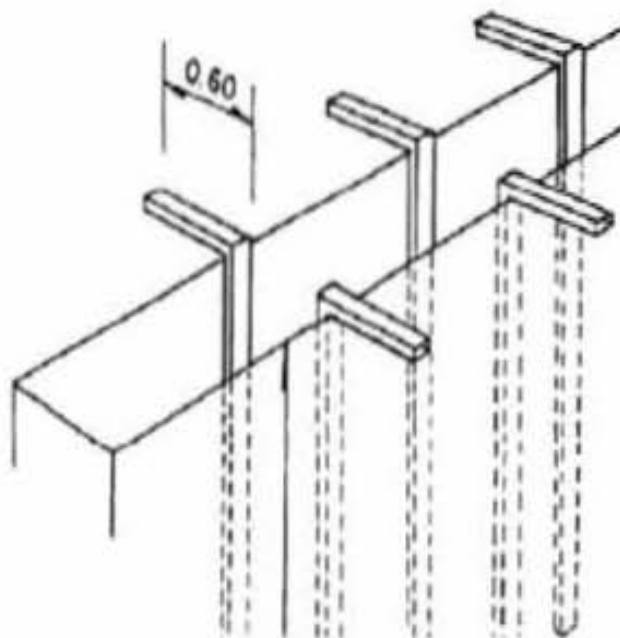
y 6.3b Detalle de la colocación de armaduras
